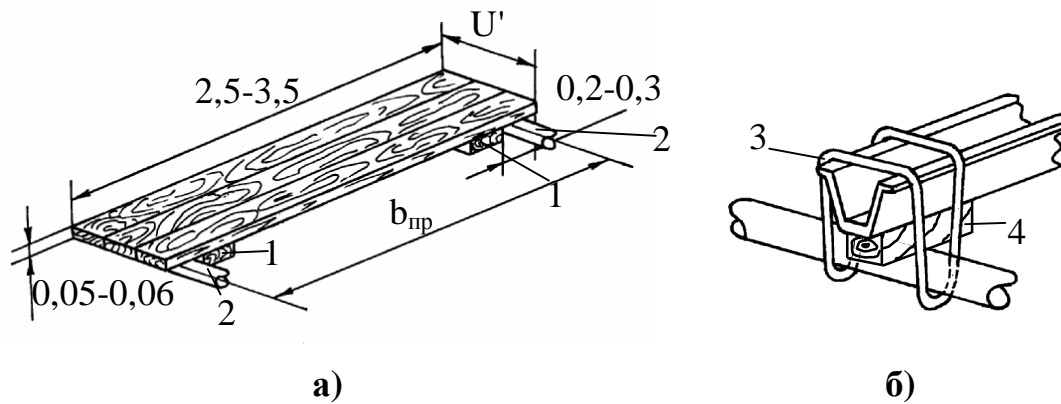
Конструкция деревянного полка перекрытия (а) временной опережающей крепи с прогоном из трубы (б): 1 – стяжной отрезок деревянного бруса; 2 – труба; 3 – фигурная скоба; 4 – клин деревянный
